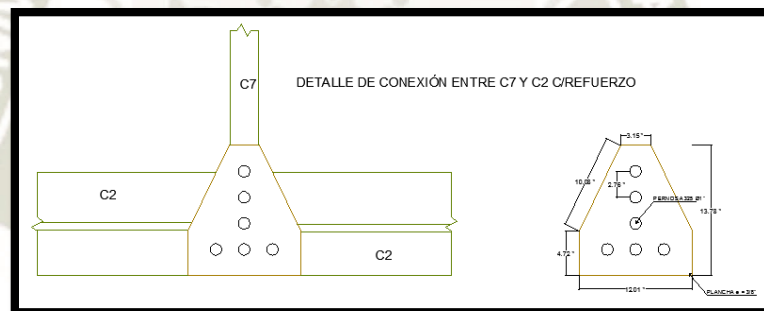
Detalle de conexión de secciones C7 c/refuerzo
